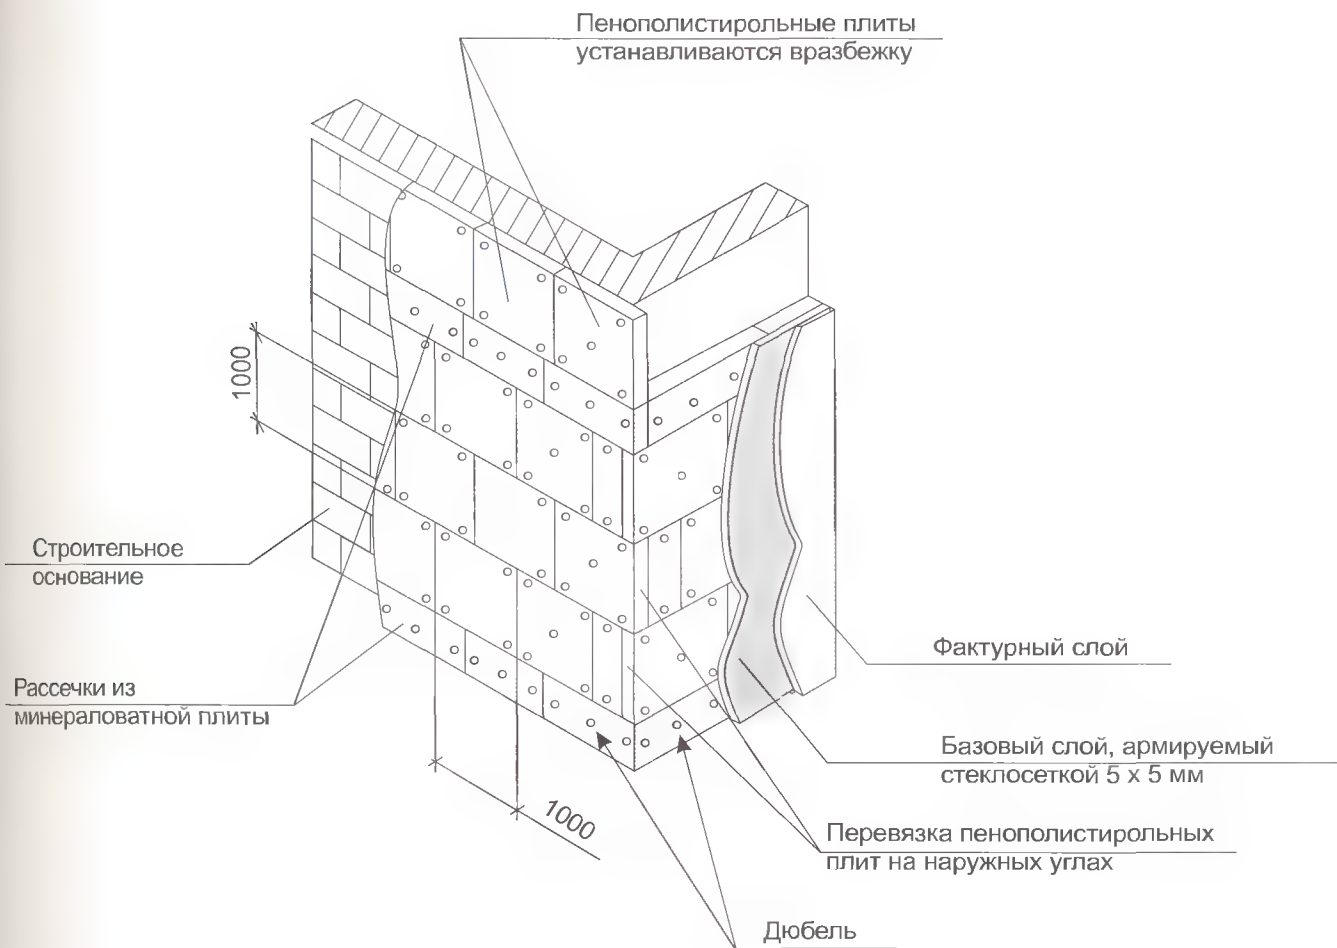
Система наружной теплоизоляции фасадов с применением в качестве утепления пенополистирольных плит «ЛАЭС-П»
